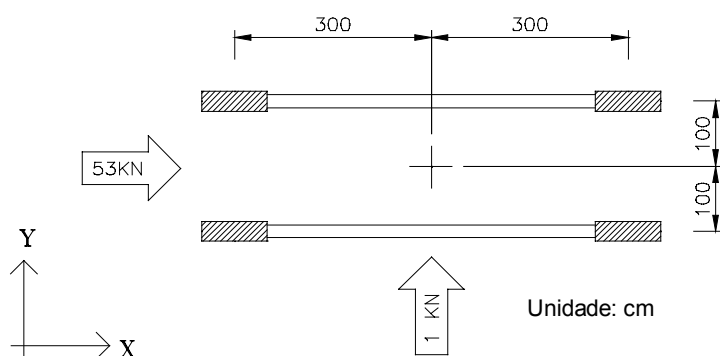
Estrutura sem consideração das vigas secundárias - caso 01
